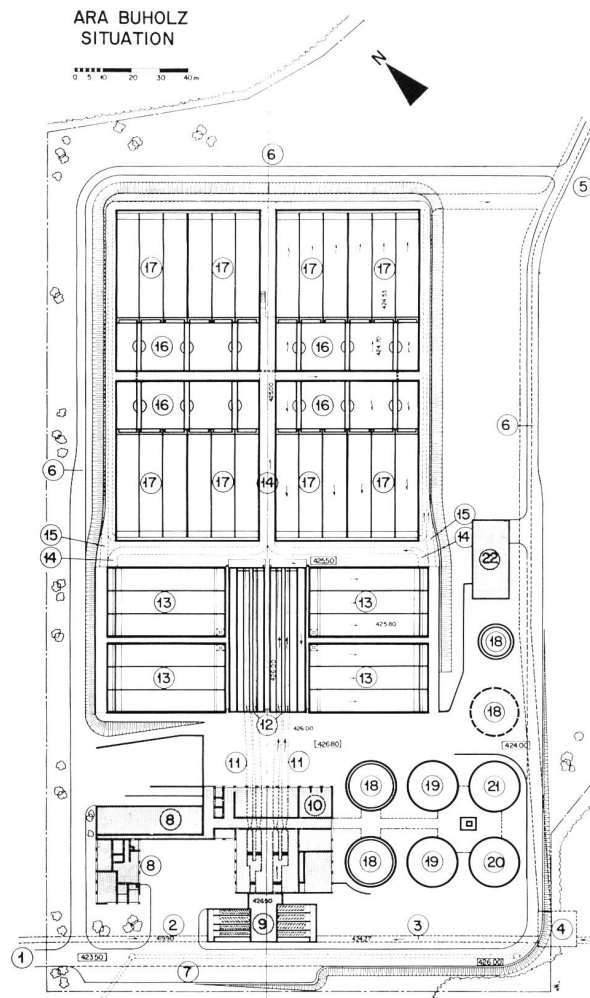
Lageplan der im Bau stehenden Kläranlage Buholz für Luzern und Umgebung
